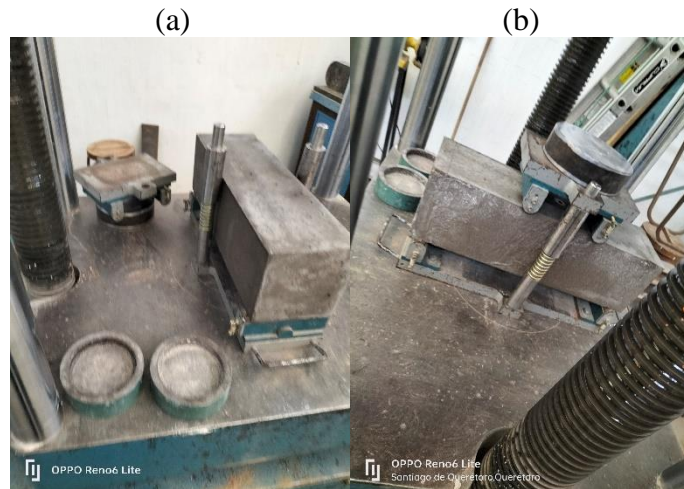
Montaje de viga en prensa (a), Ensayo de vigas fibradas con 2.5% PEAD en 6x20mm (b).
